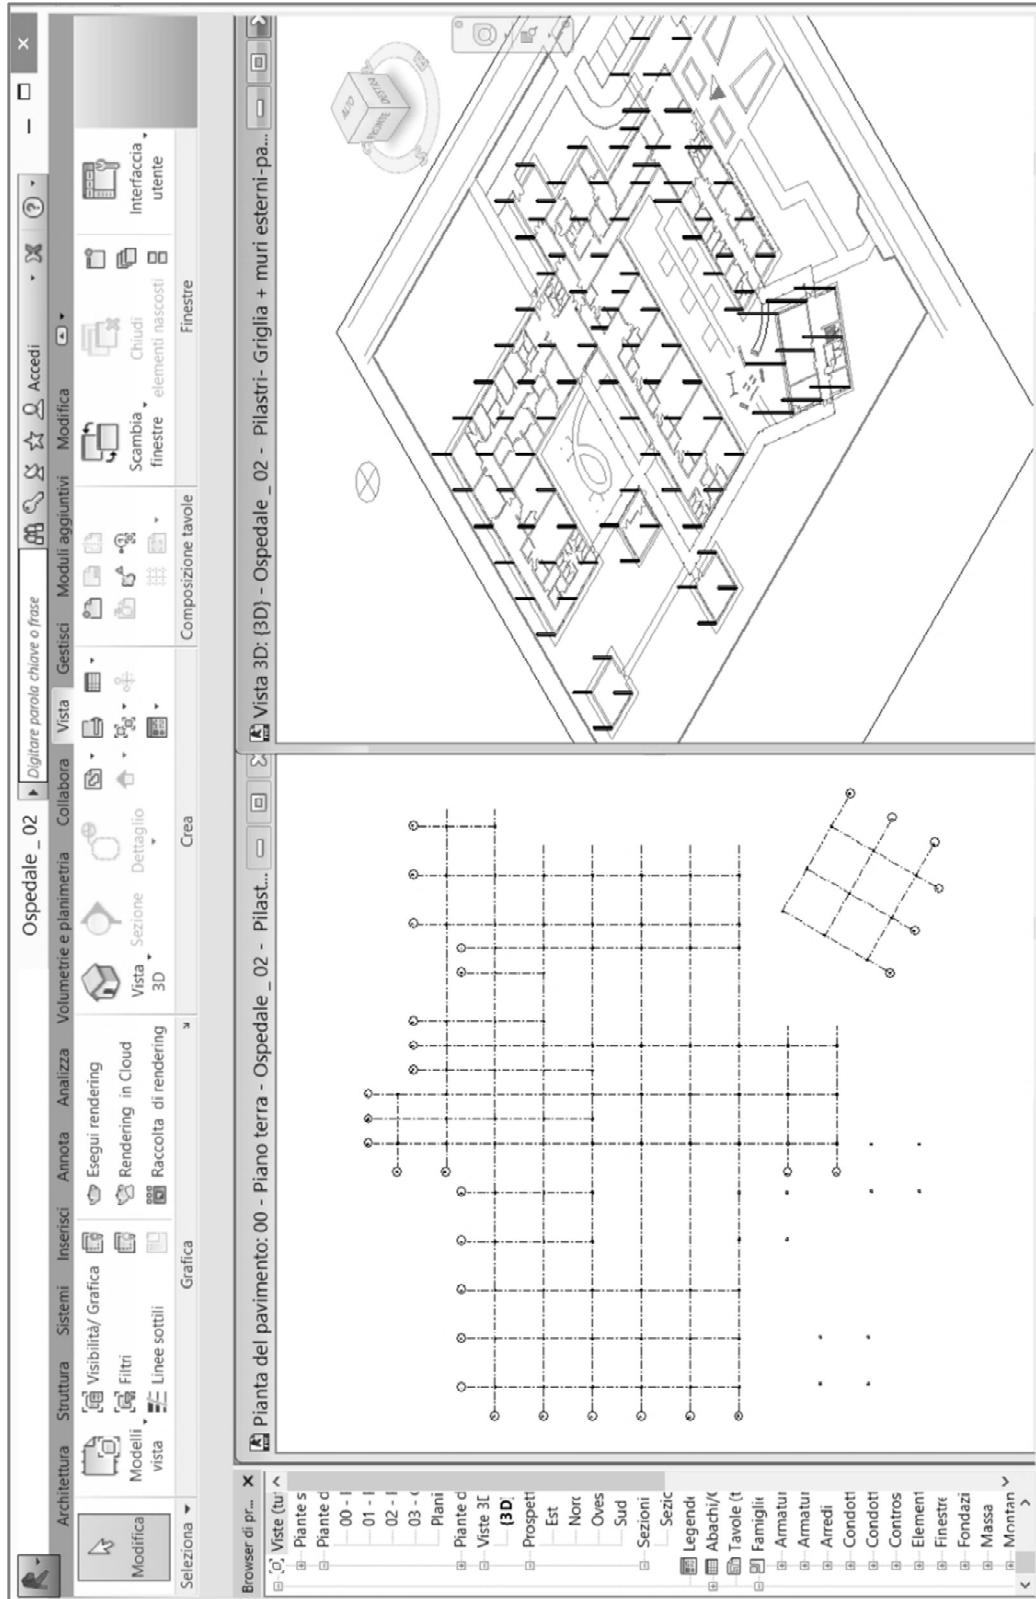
Modellazione della griglia strutturale di pilastri.
